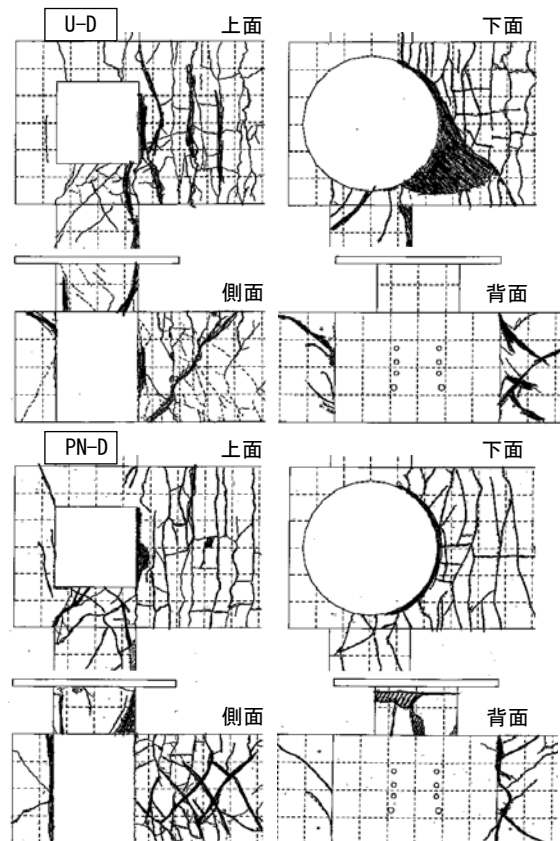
最終ひび割れ状況(上面, 下面, 側面, 背面図)
